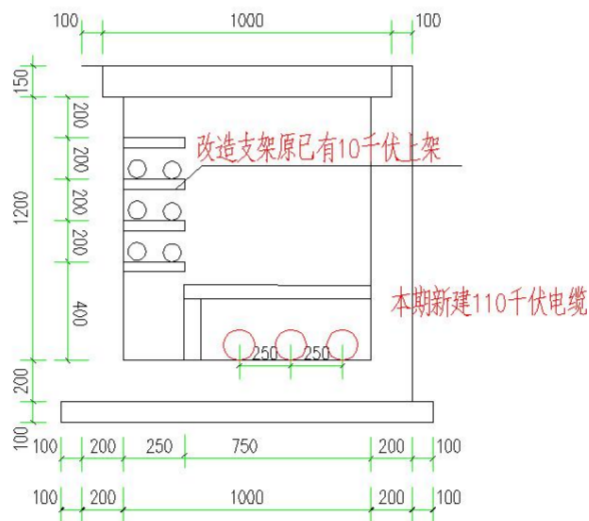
上坪侧 10kV 电缆沟断面改造示意图（单位：mm）
